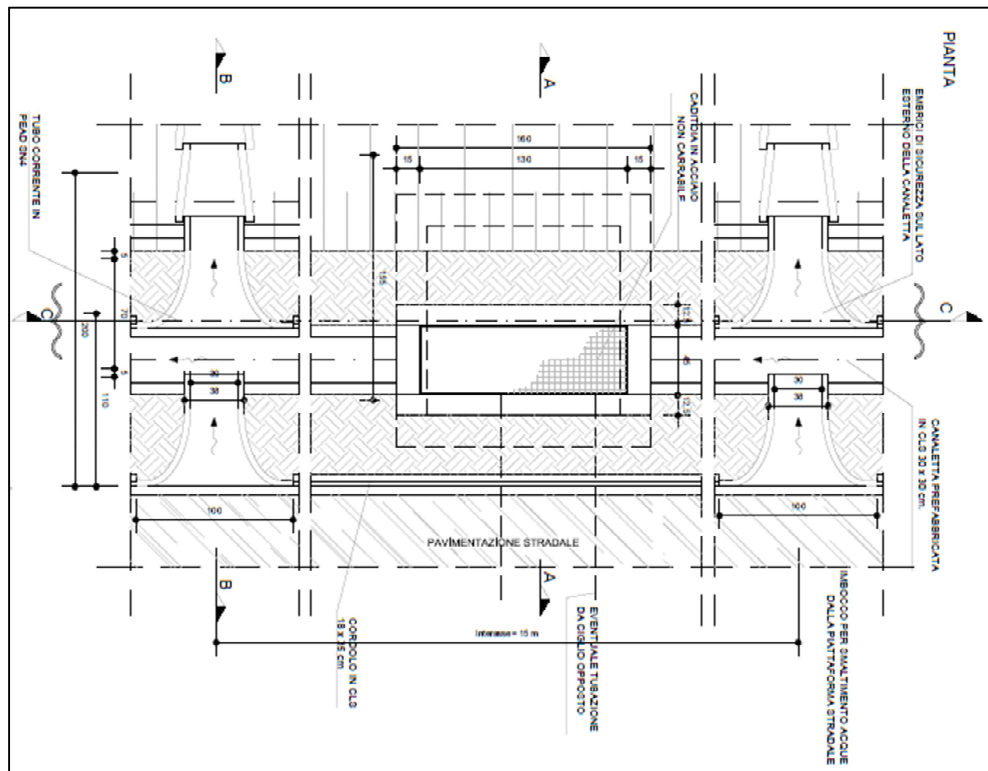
Particolare del sistema di raccolta di tipo chiuso – Vista in pianta
